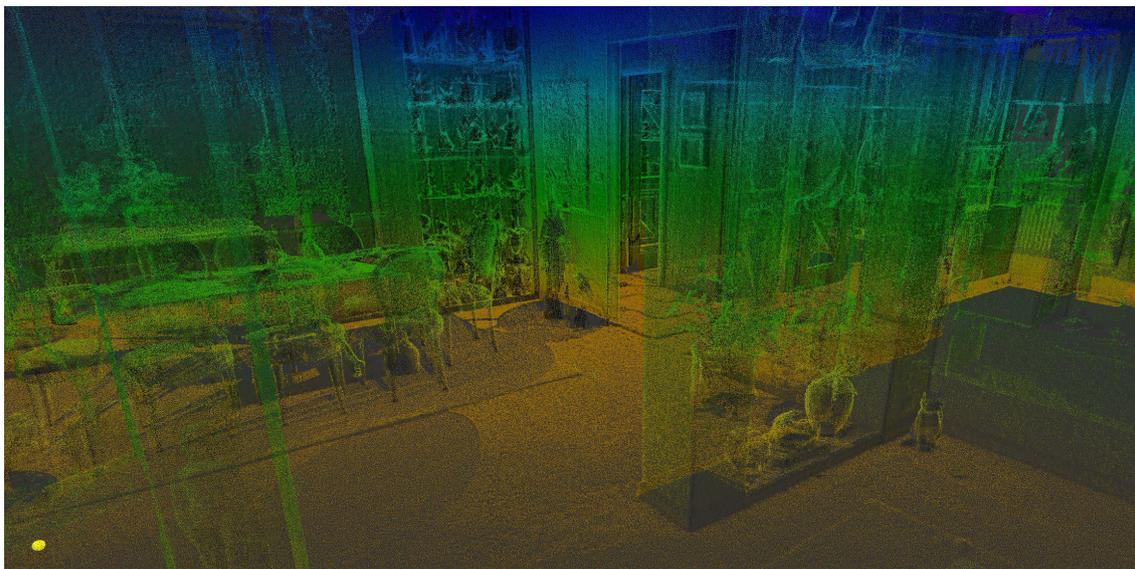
Pointcloud zona pranzo (valori elevazione)
